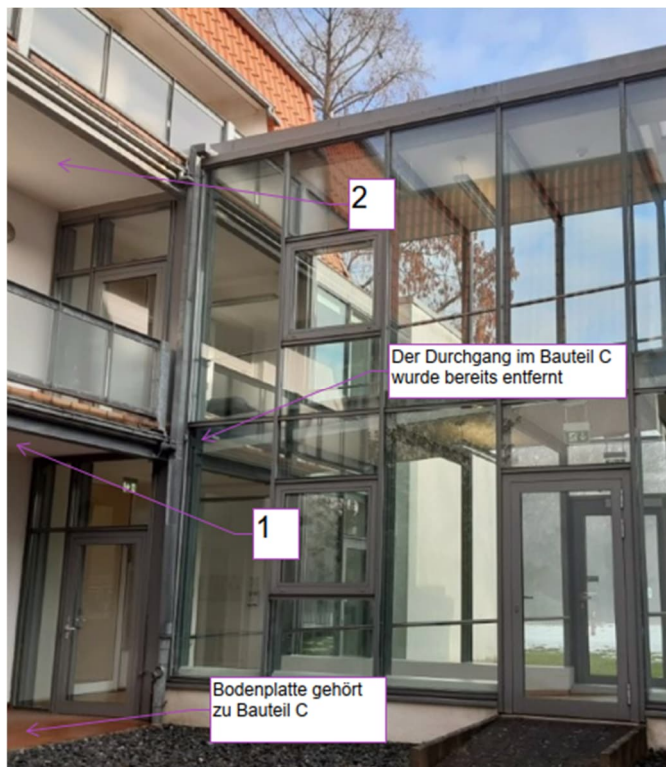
Foto Übergang Bauteil F zu Bauteil C
